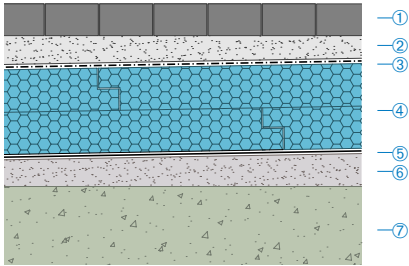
Lastspridning i parkeringsdäck med beläggingssten
